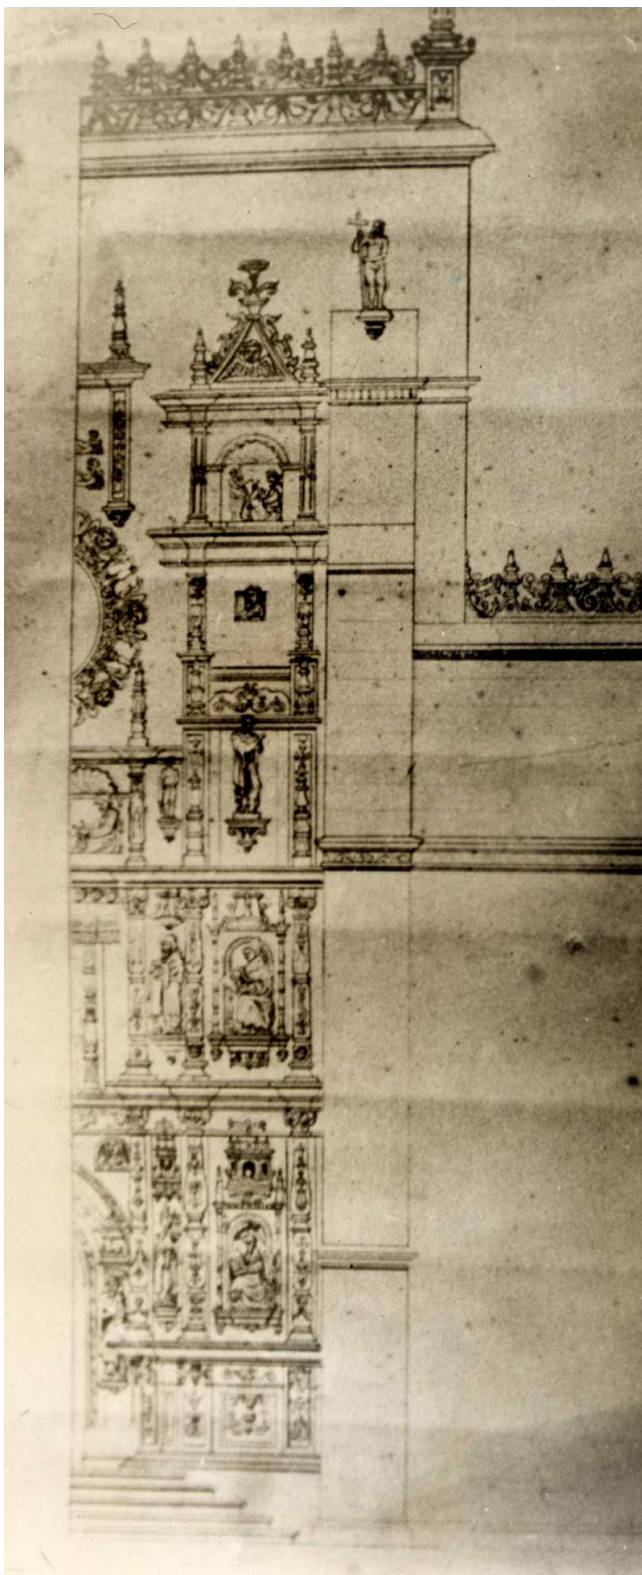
"Debuxo da traza da fachada de Sta. María, Pontevedra"
